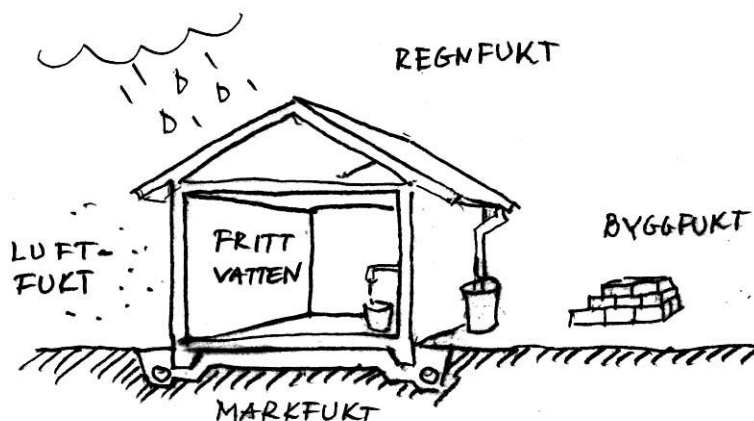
Fukten angriper en byggnad från både ut- och insida, men leder aldrig till några skador så länge vi vet hur vi ska handskas med den.
